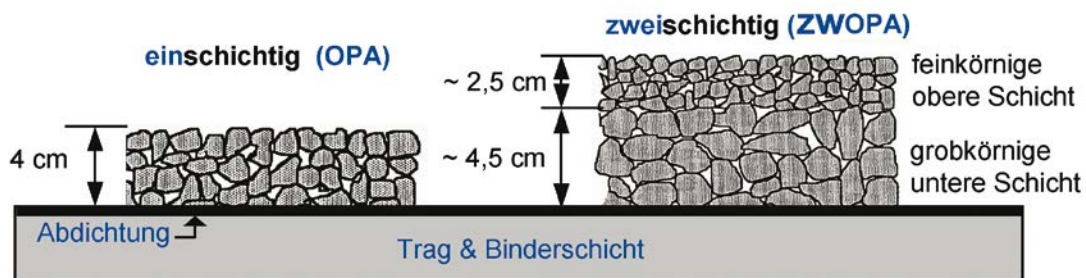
Offenporiger Asphalt – Deckenaufbau
